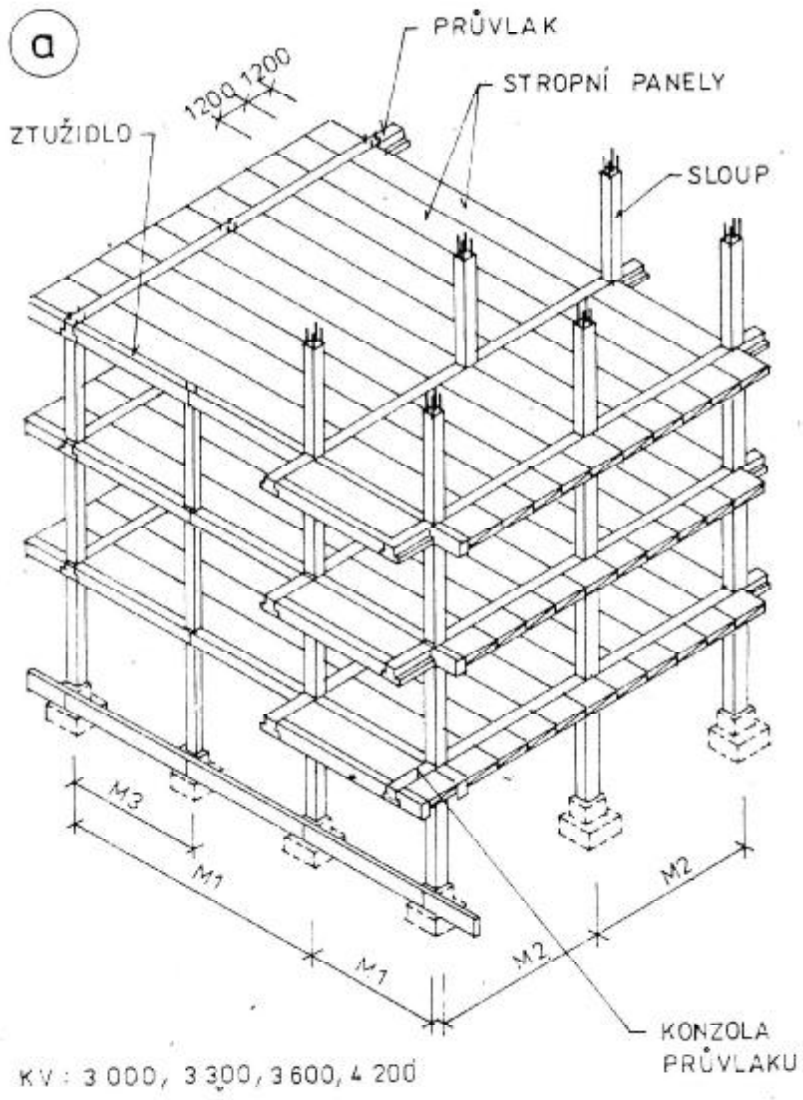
Monolitický železobetonový skelet - konstrukční systém rámový:
